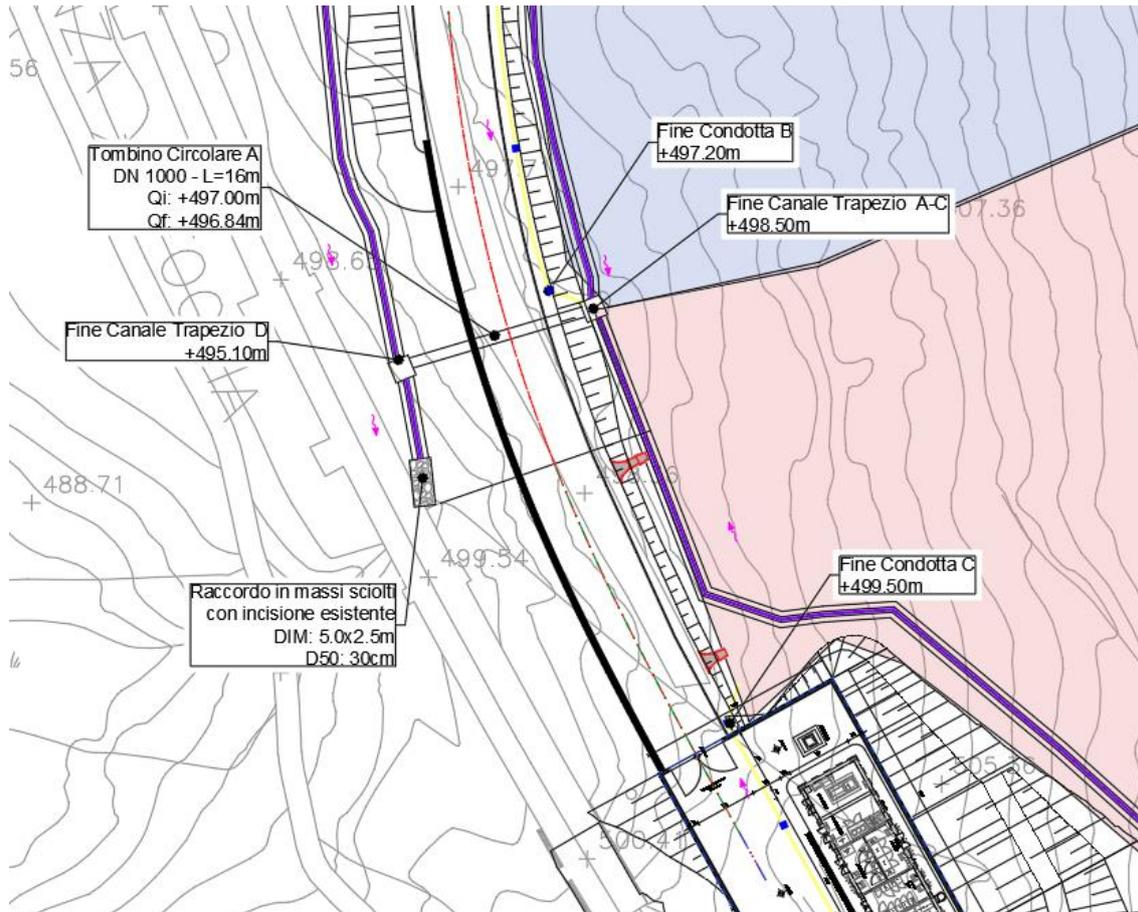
estratto planimetria di drenaggio viabilità NV19
